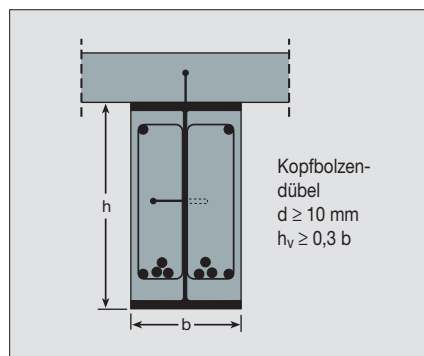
Sicherung des Verbundes zwischen Stahlprofil und Kammerbeton durch angeschweißte Kopfbolzendübel an den Profilsteg
